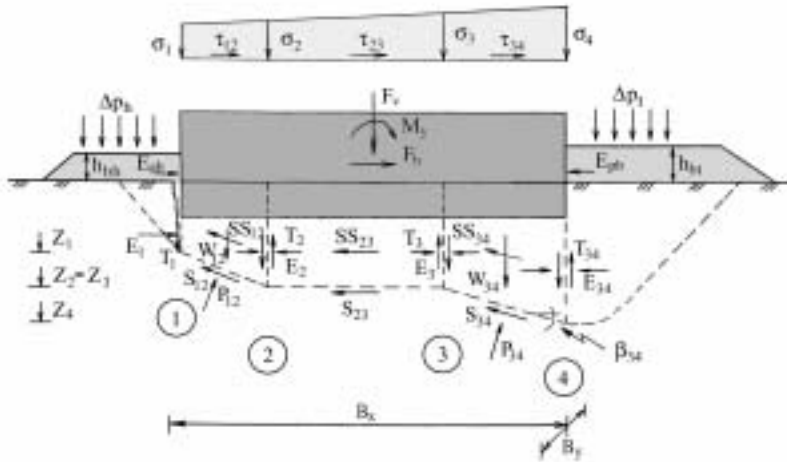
Расчетная схема при глубинном сдвиге с выпором грунта основания
